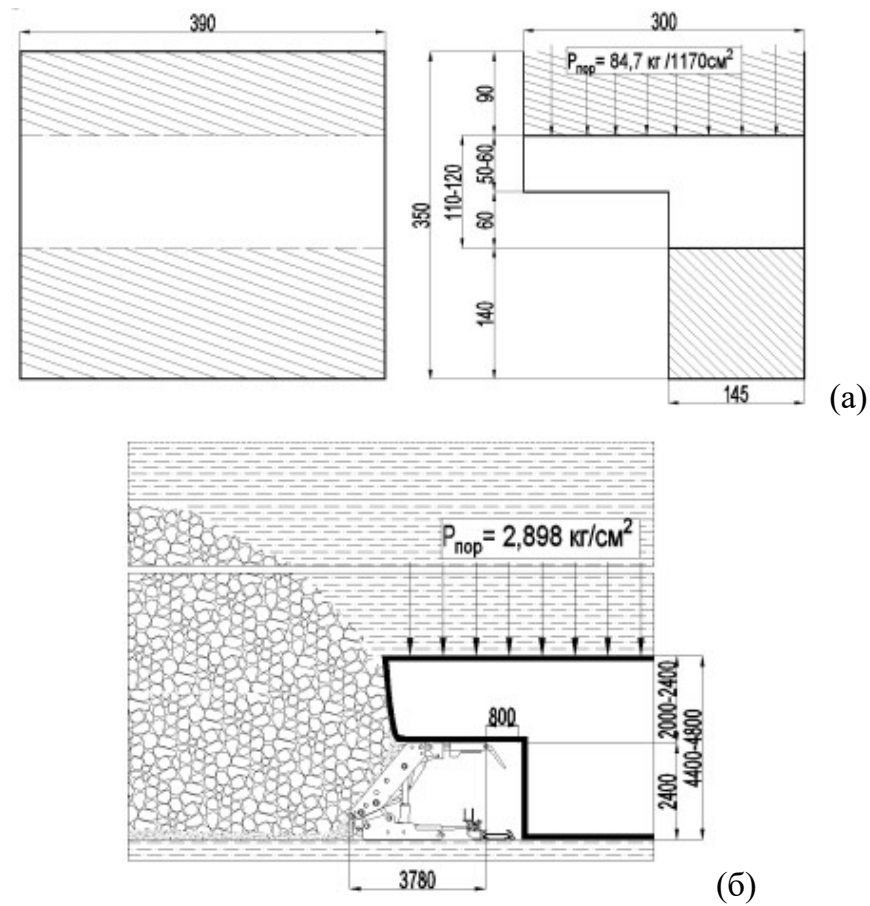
Система разработки с выпуском угля подкровельной толщи
